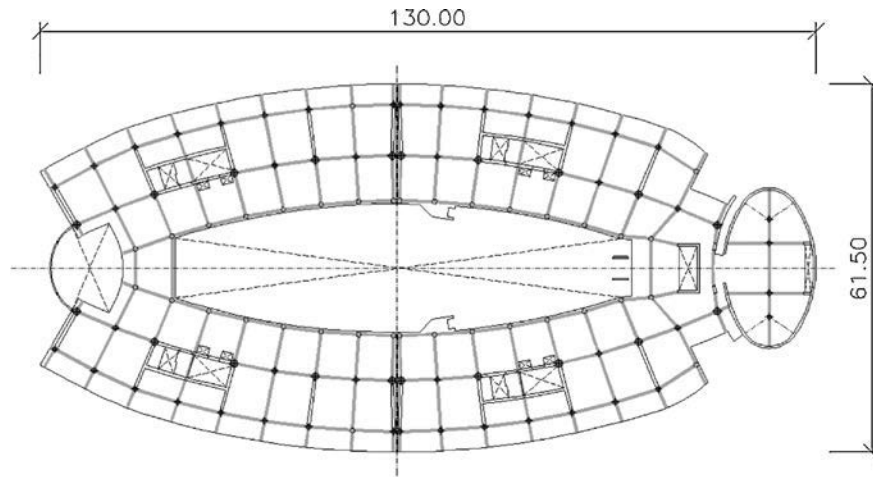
Estación Bir Mourad Raïs (Argel). Vigas y pilares plantas superiores.
